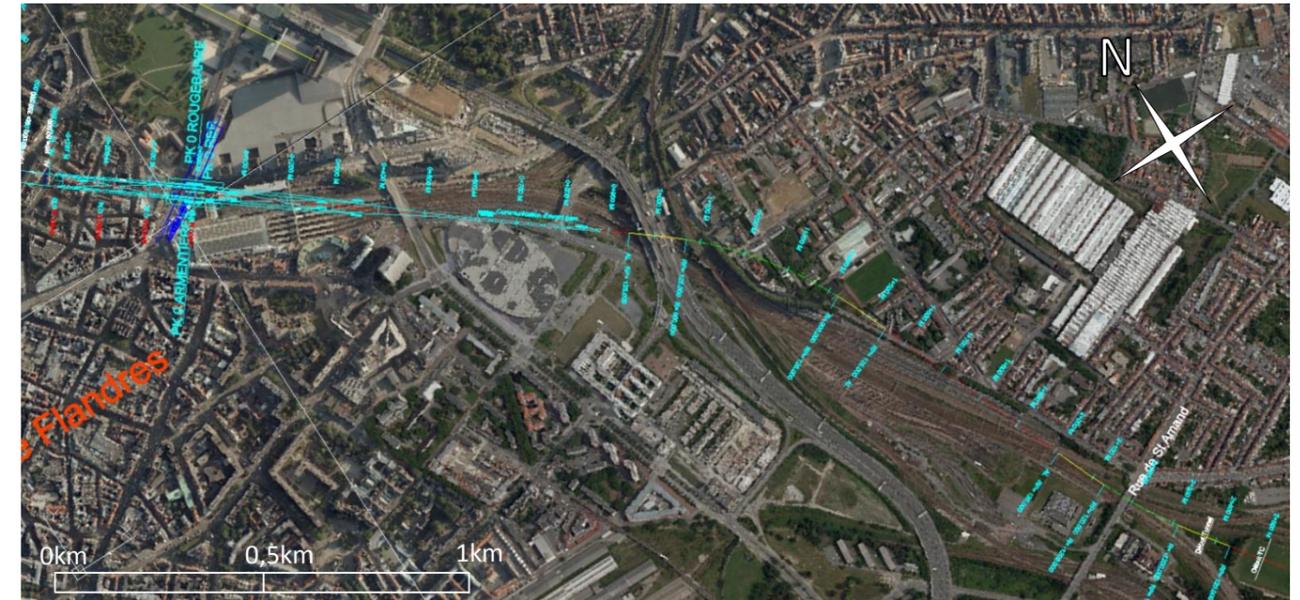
Traversée de Lille en souterrain : Implantation en plan et en profil du tracé de référence
